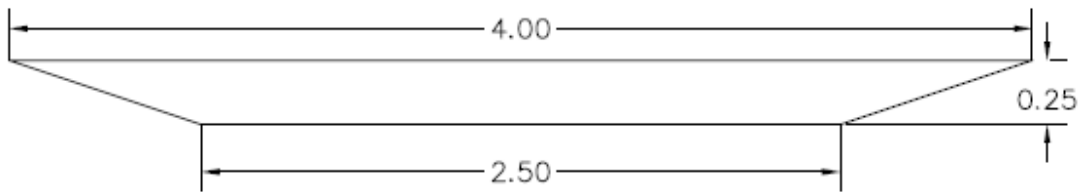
Sección re-dimensionada de hormigón pretensado maciza.
